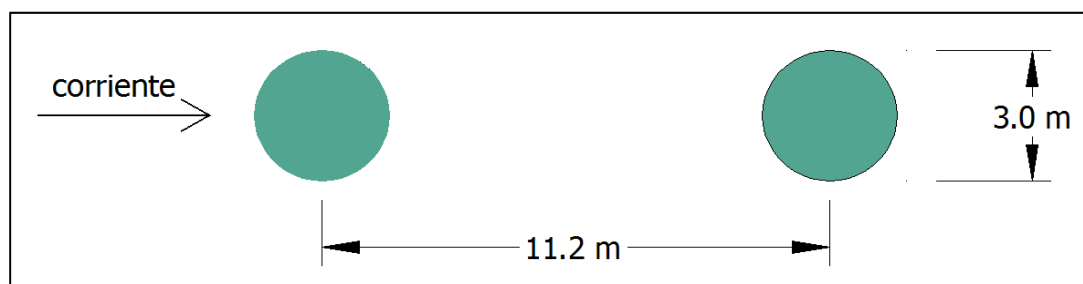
5, Sección de Pila puente “Picota”.^{PA}
